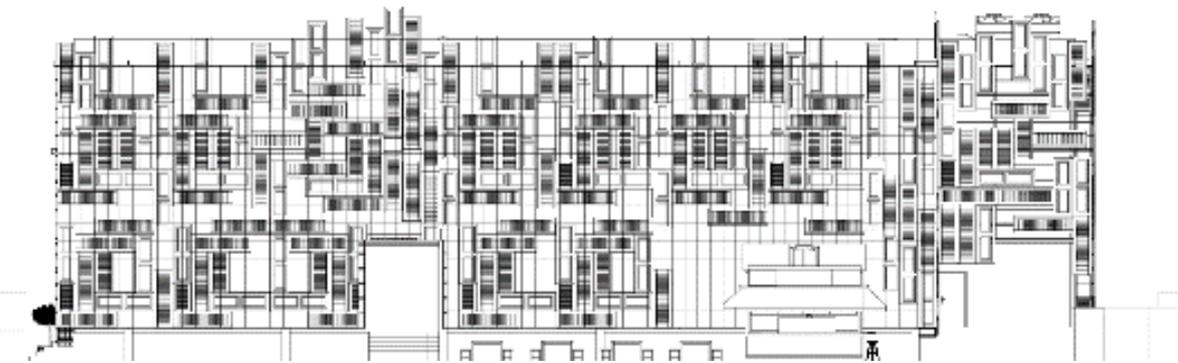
Detail Fasad dari Bahan Jendela Bekas
